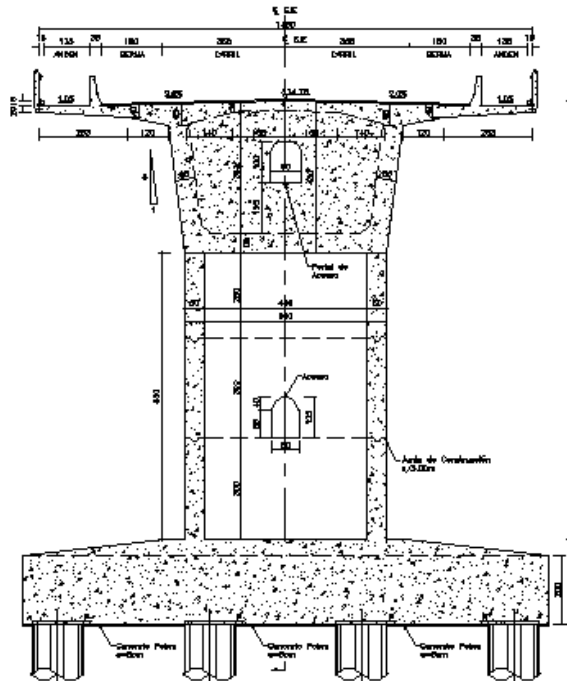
Geometría apoyos ejes 4 y 5 – Puente San Pedro
